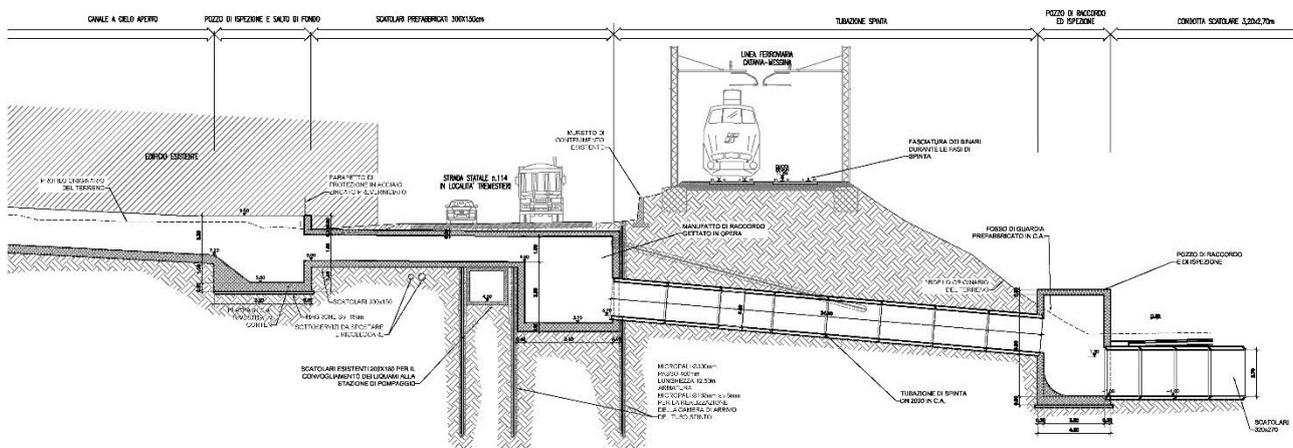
profilo dell'attraversamento nella nuova soluzione proposta
